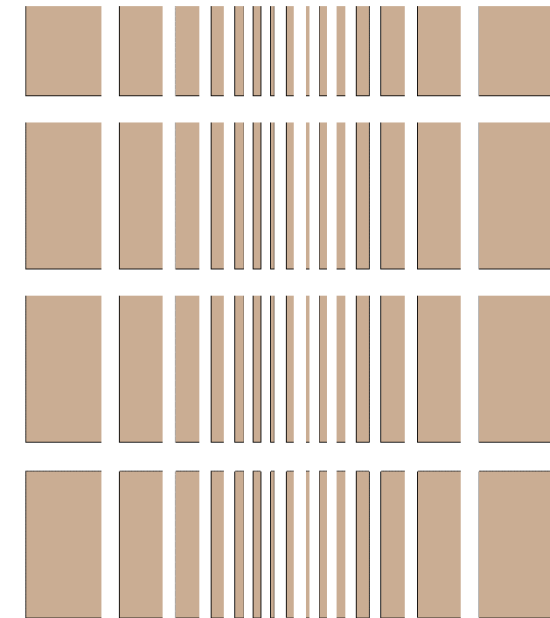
Detalle patrón en cielo. Fuente: Elaboración propia.
